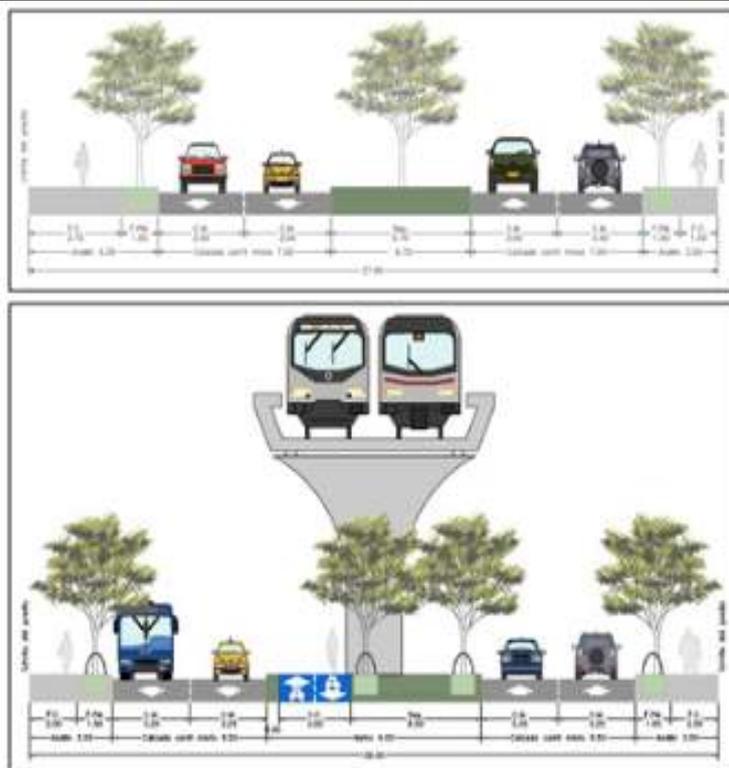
Sección transversal en la Calle 1 entre la Carrera 27 y la Avenida Caracas.
